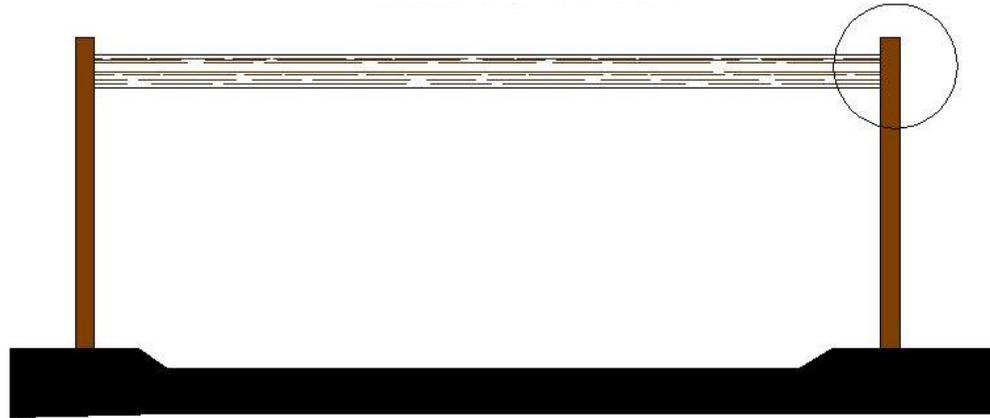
DETALLE DE APOYO VIGA CONTRA PILAR
